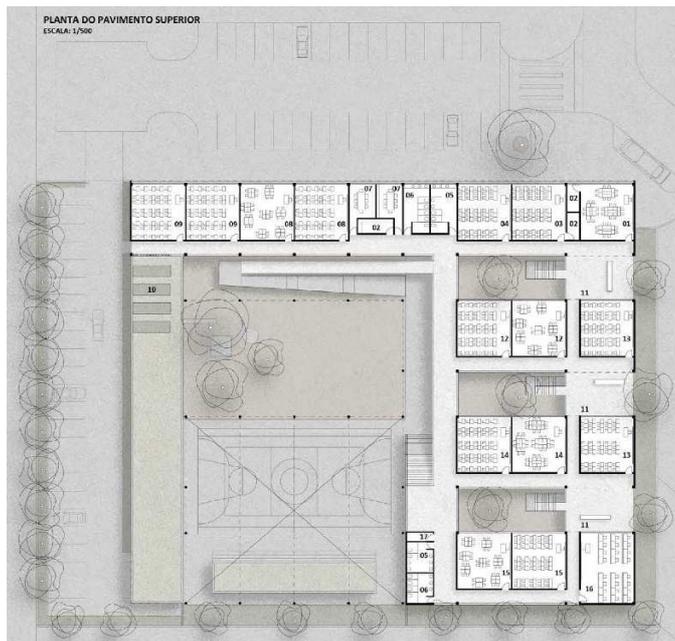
Planta baixa (superior) - CEF 247 (Fonte: CODHAB, 2016b)
